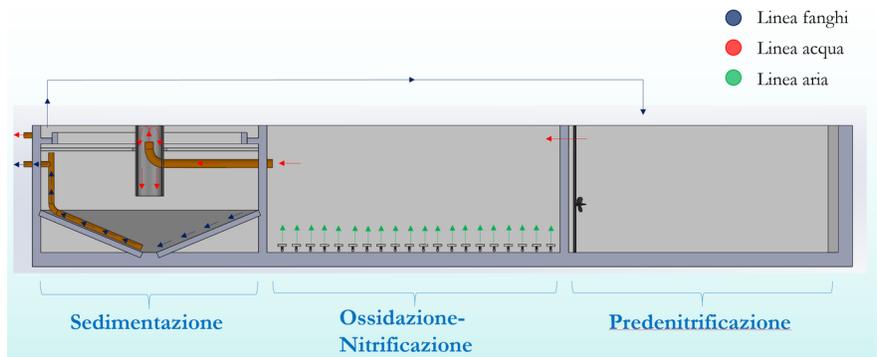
Sezione impianto convenzionale a fanghi attivi (CAS)
